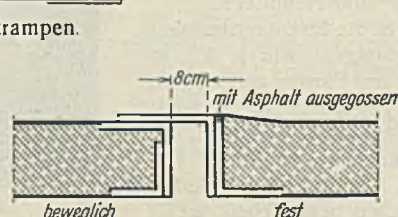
Dehnungsfuge in der Fahrbahndecke der Zufahrtrampen.
